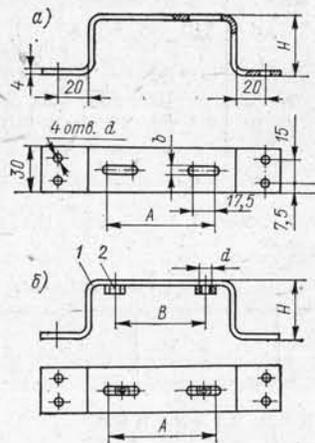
Мосты для установки светильников, закрепляемые винтами: а — на конструкциях без зашивки изоляции; б — на конструкциях под зашивку изоляции.
